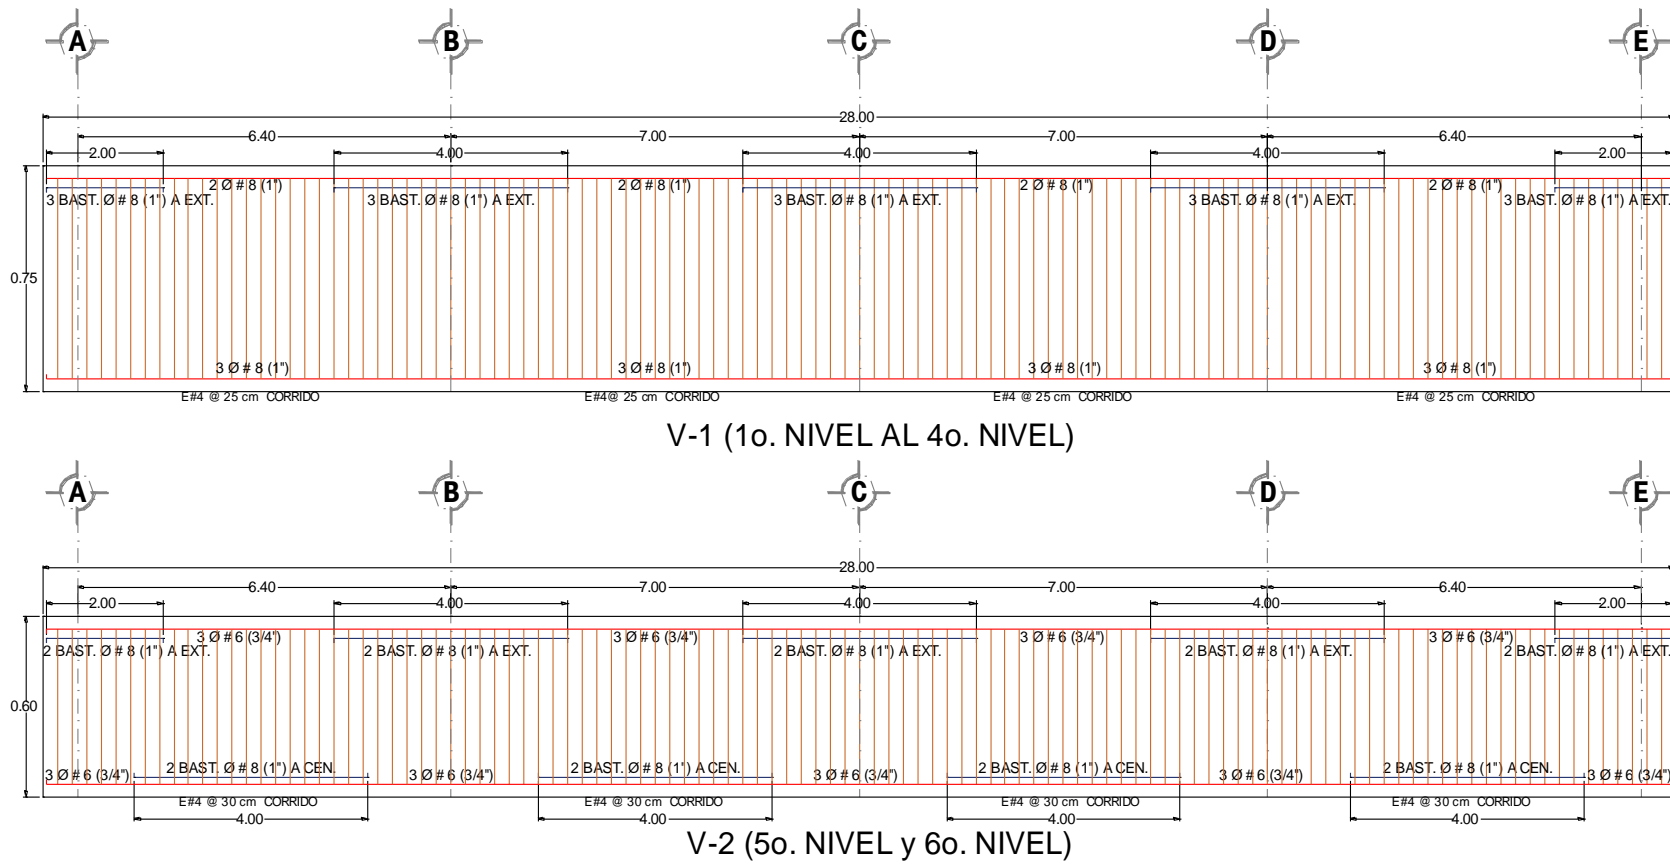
Detallado de armado de vigas de marco del 6 niveles con base a la hipótesis de las NTCC-17.
